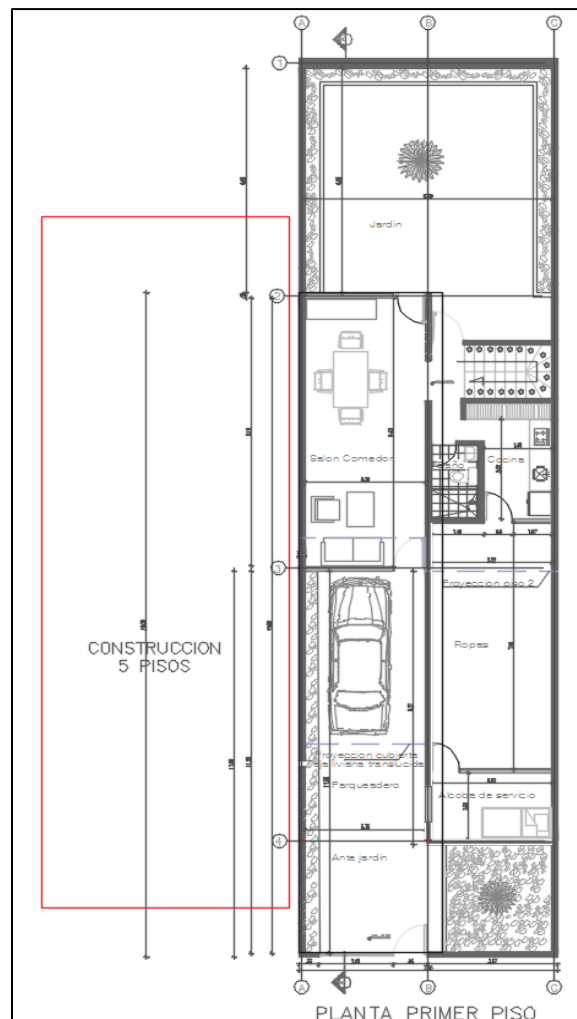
Plano arquitectónico piso 1. Fuente: Los autores
